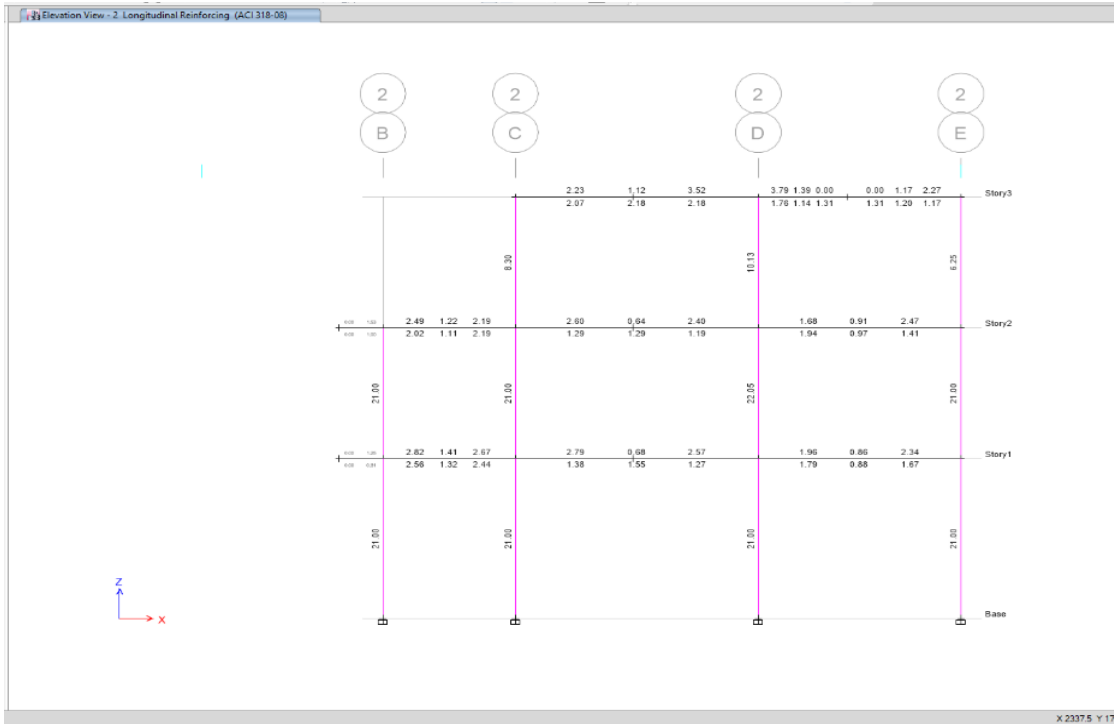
Plano del diseño de acero en columnas – Pórtico 1 - 1
